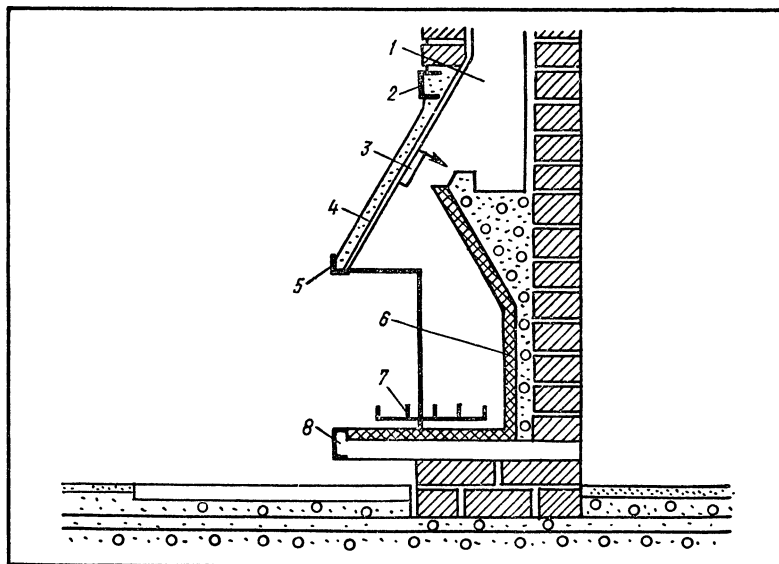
Конструкция камина с металлическим дымоборником (ЧССР): 1 — дымоход; 2 — перемычка (швеллер); 3 — дымовая заслонка; 4 — металлический кожух дымоборника; 5 — рама, поддерживающая дымоборник (уголок); 6 — железобетонный закладной корпус топки; 7 — корзинка для сжигания топлива; 8 — рама (швеллер), поддерживающий под топки.
